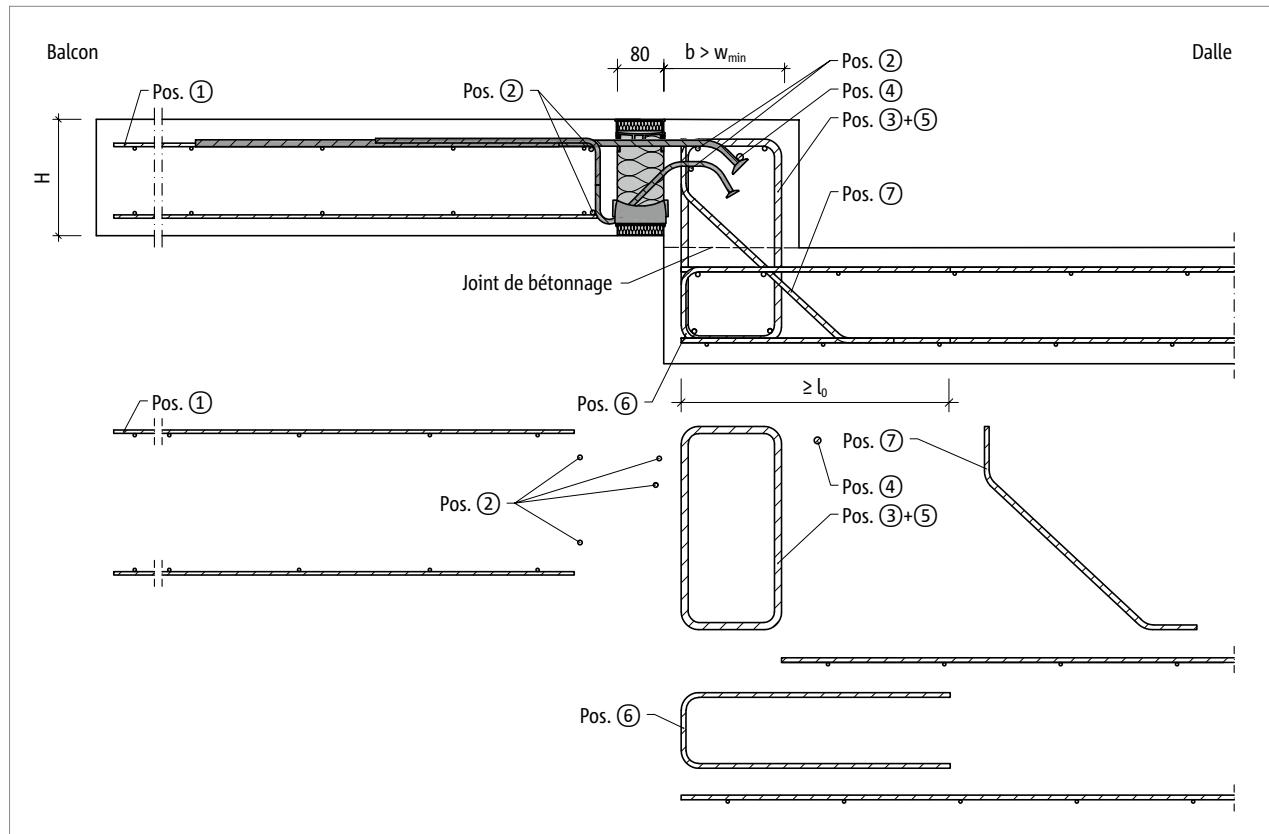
Schöck Isokorb® T type K-O-F : Renforcement sur site pour balcon avec décalage vers le haut avec une dimension plus grande du composant ($w_{\text{prés}} > w_{\text{min}}$)
